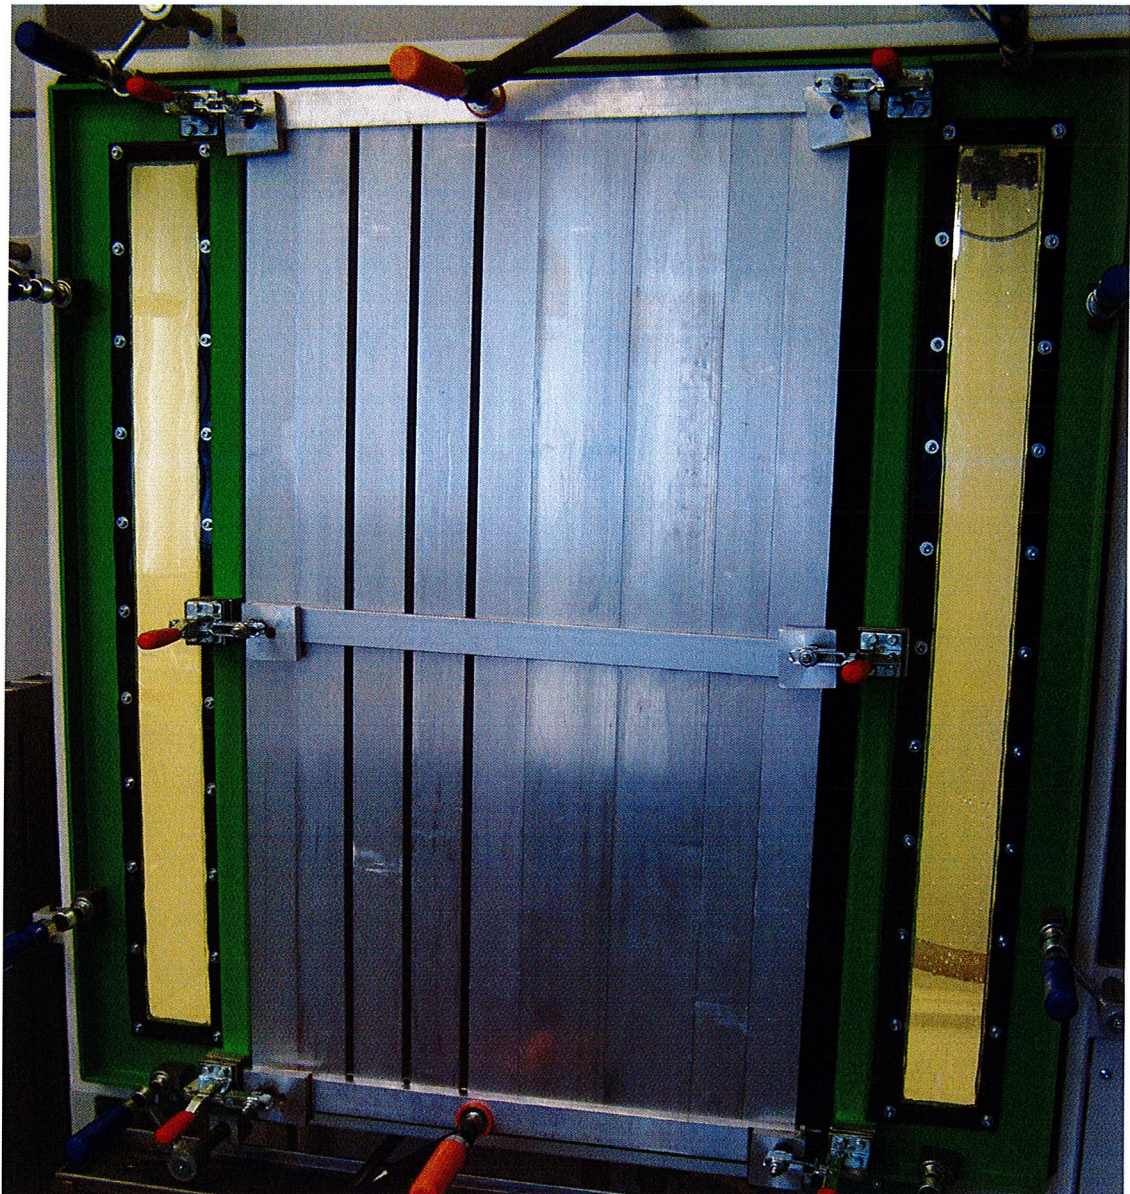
Prüfkörper mit Standard-Längsfugen, eingebaut im Prüfstand
